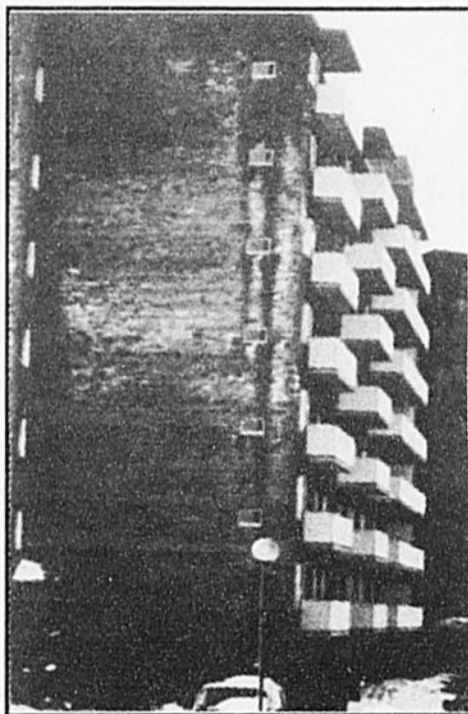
Taches d'efflorescence causées par les fuites d'air et la condensation dans le mur.
